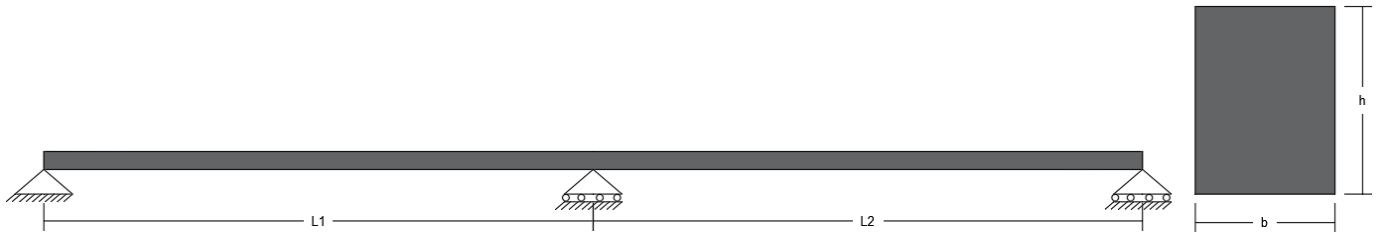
Viga de dos luces - Corte transversal y longitudinal.
